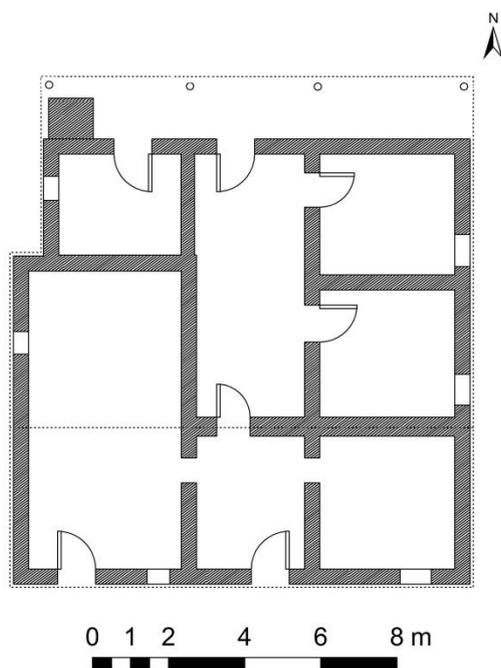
Planta baixa da sede da fazenda Água Verde. *Fonte: elaboração própria.
